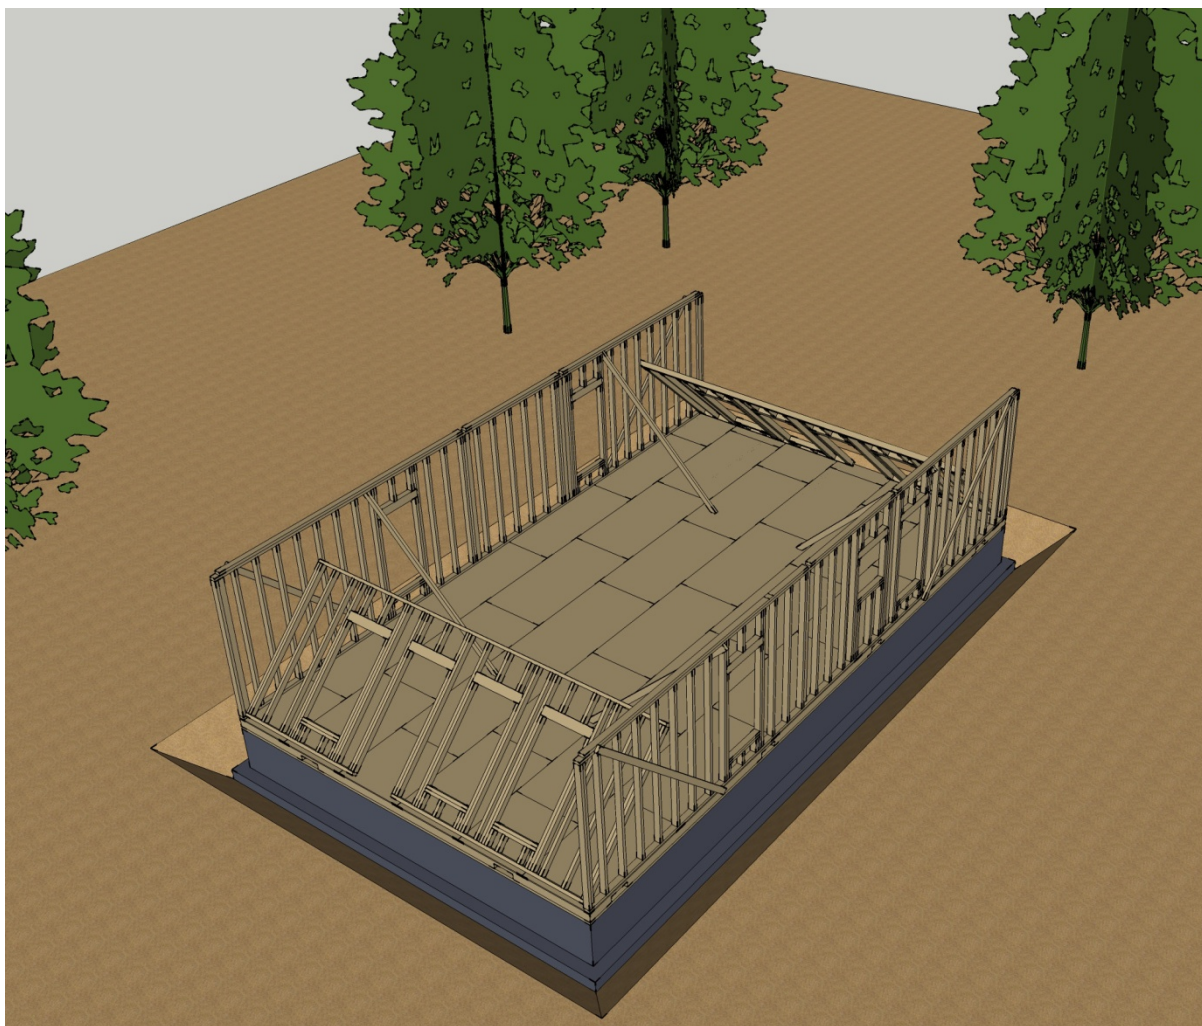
Levantamento manual das paredes exteriores de topo.
